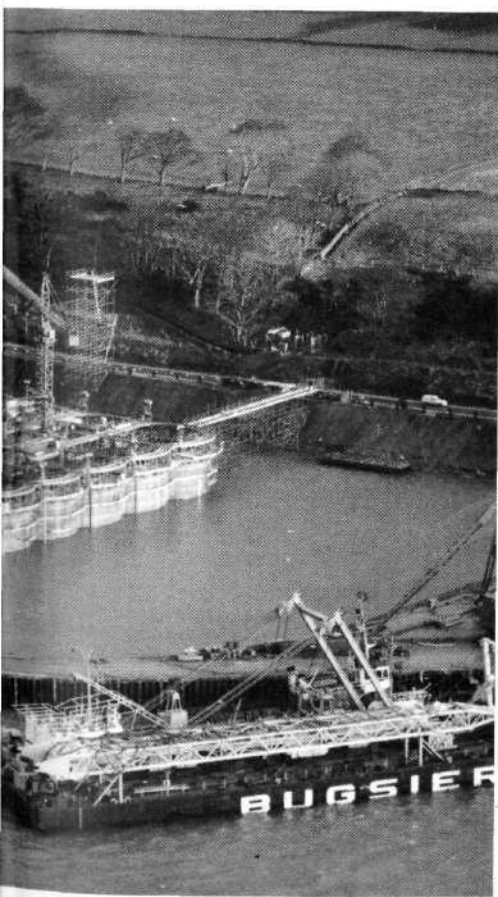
pendant la construction du caisson en coffrages glissants, la plate-forme, qui s'enfonce progressivement, est reliée à la terre par une passerelle flottante ; celle-ci supporte les canalisations qui transportent le béton pompé jusqu'au sommet des murs.
